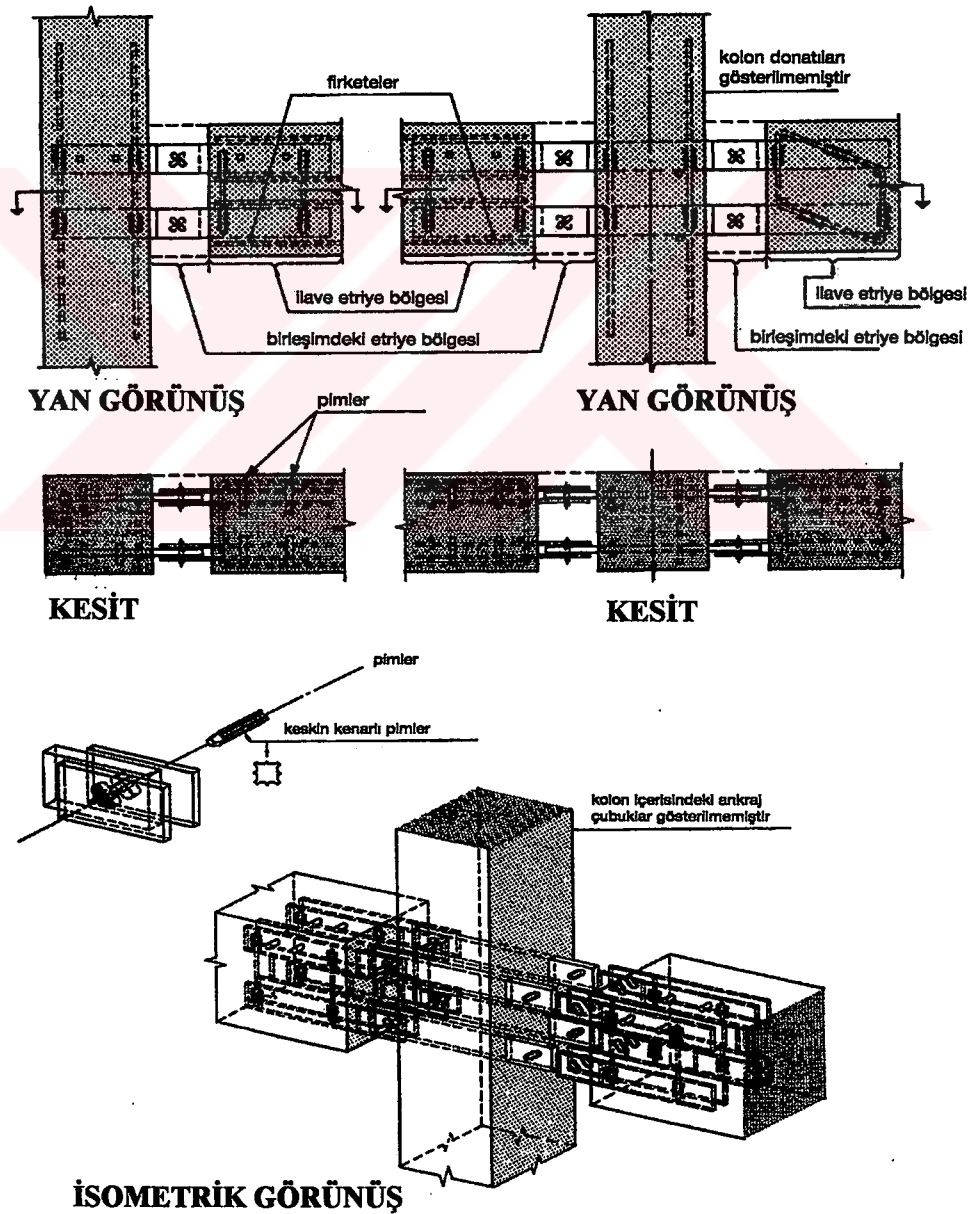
Kirişteki yerinde dökme betonla kolon-kiriş birleşimi
